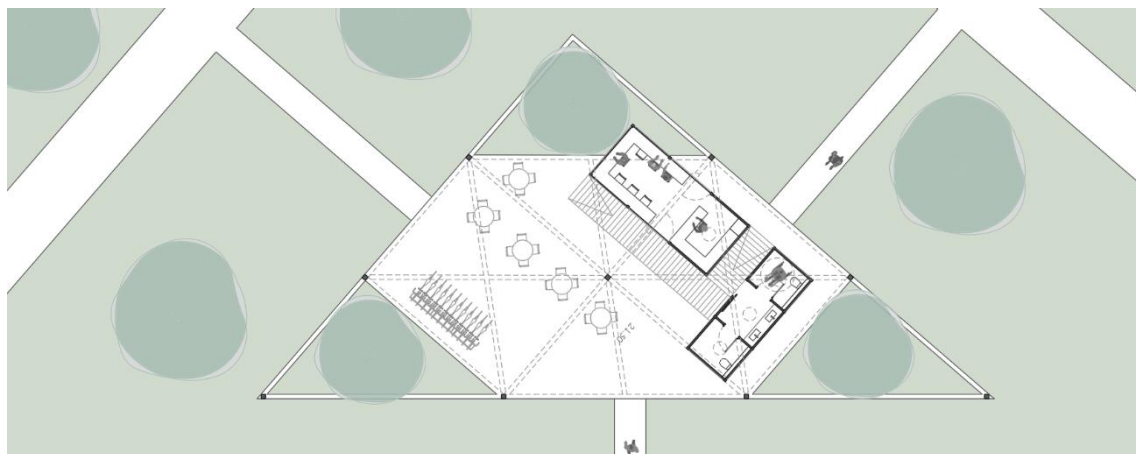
PC – Pérgula, planta piso térreo (elaborado pelo autor)
